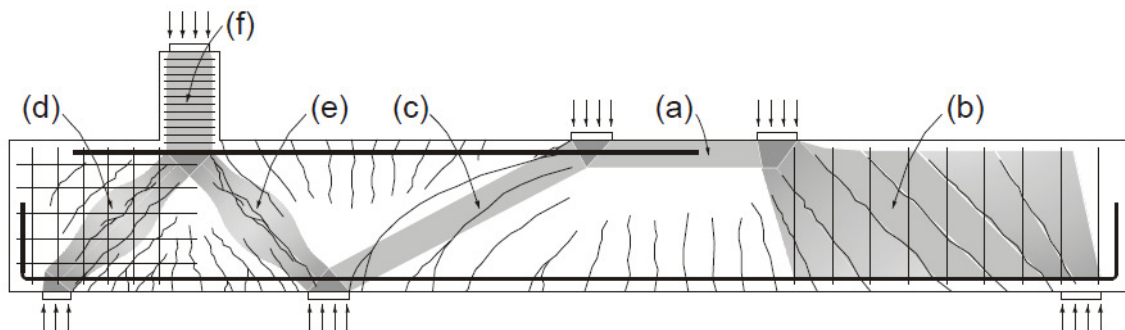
Tipos de escoras em Regiões D: (a) escora prismática em região não-fissurada, (b) escora prismática em região fissurada onde as escoras são paralelas às fissuras, (c) escora prismática em região fissurada onde as escoras não são paralelas às fissuras, (d) escoras garrafa com armadura em malha para controle da fissuração, (e) escora garrafa sem armadura de controle de fissuração e (f) escora confinada (TJHIN e KUCHMA, 2002)
